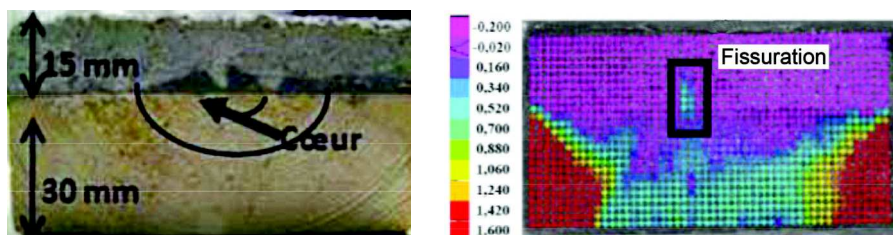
assemblage épicea-BFUP et observation par corrélation d'images numériques d'une fissure dans le béton induite par un chargement hydrique dans le plan transverse du bois
